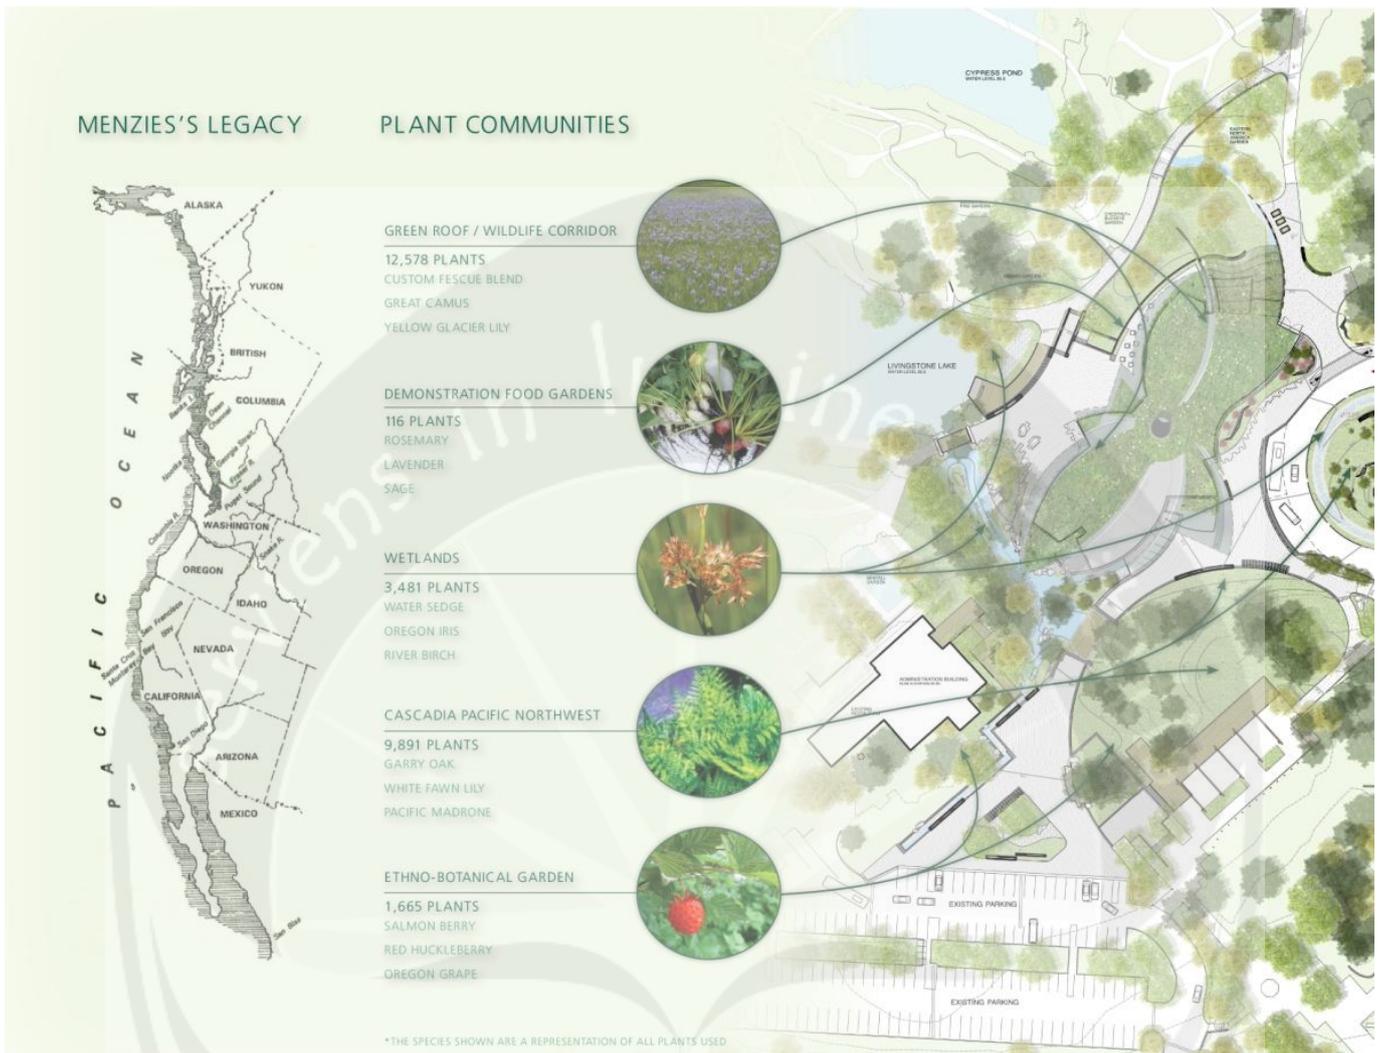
Siteplan VanDusen Botanical Garden Visitor Centre
